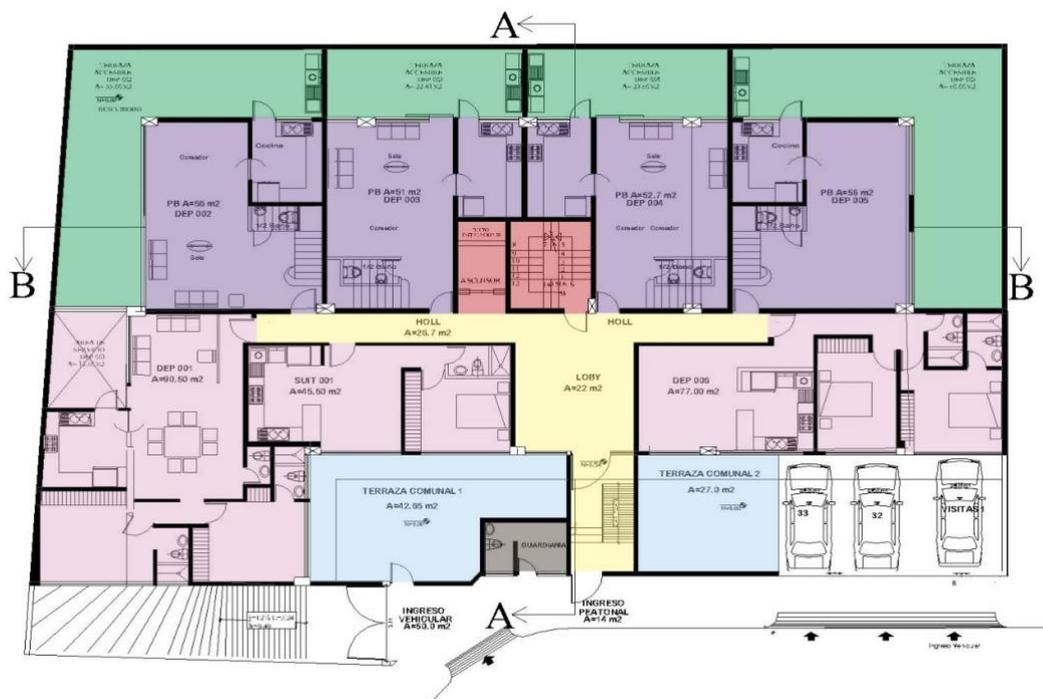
Planta Baja - AETHOS 3/ Elaboración propia
